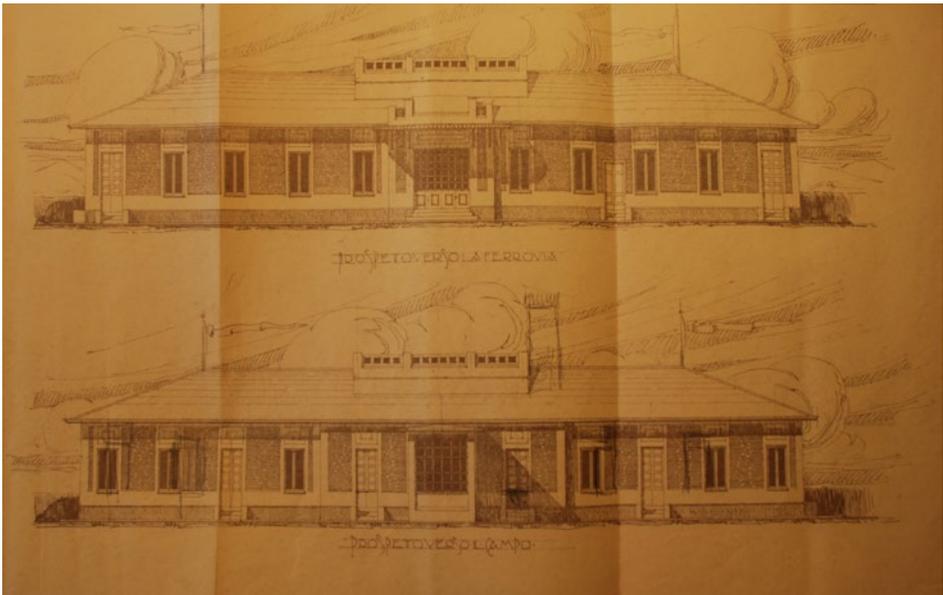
Genio aeronautico (aeroporti immobili), Sezione Demanio, 2° Zona Aerea Territoriale, Sezione di Padova, Progetto per la costruzione della stazione passeggeri "Avio Linee" all'aeroporto di Gardolo (Trento): prospetto verso la ferrovia e prospetto verso il campo.
